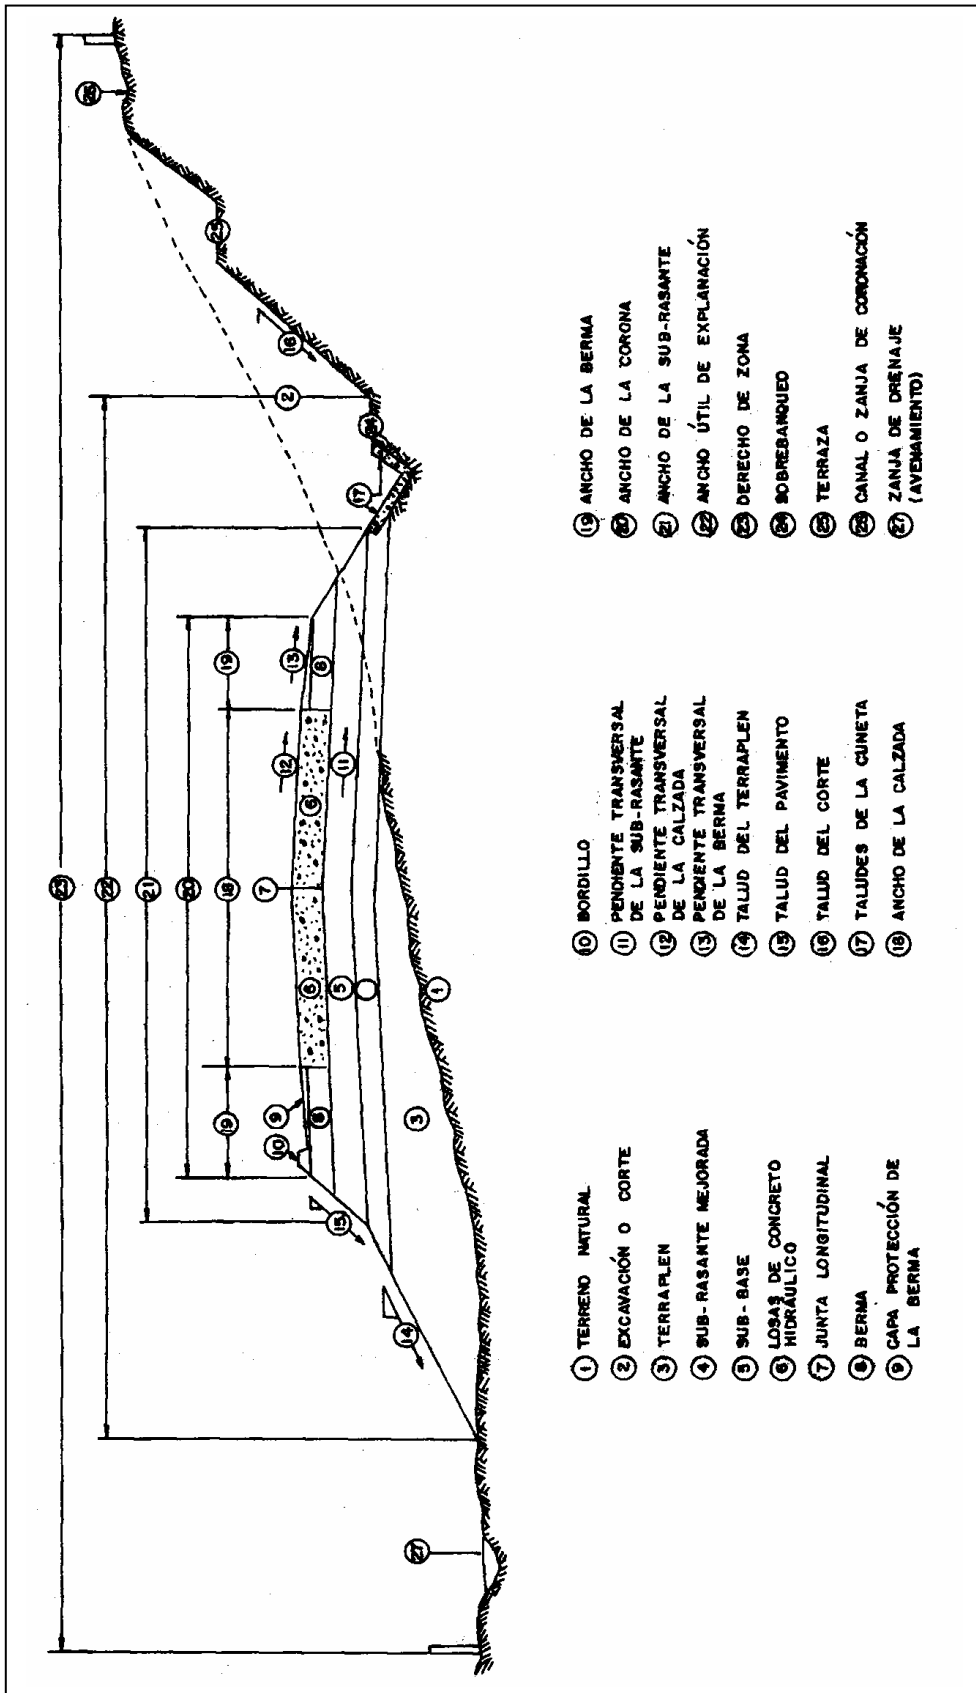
Sección Típica de un Pavimento Rígido
